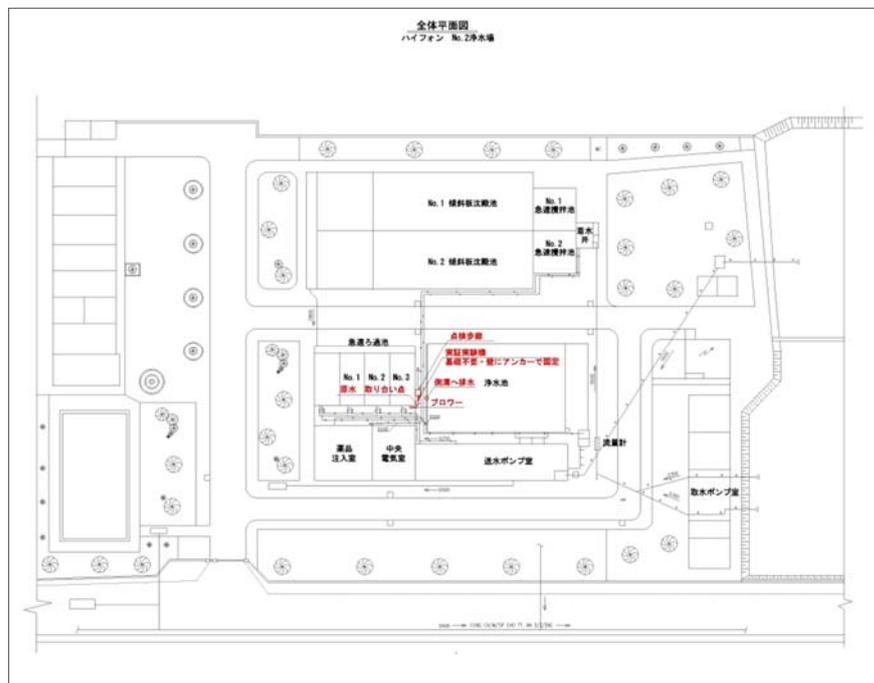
全体平面図・配置平面図 ハイフォン No. 2 水道公社
